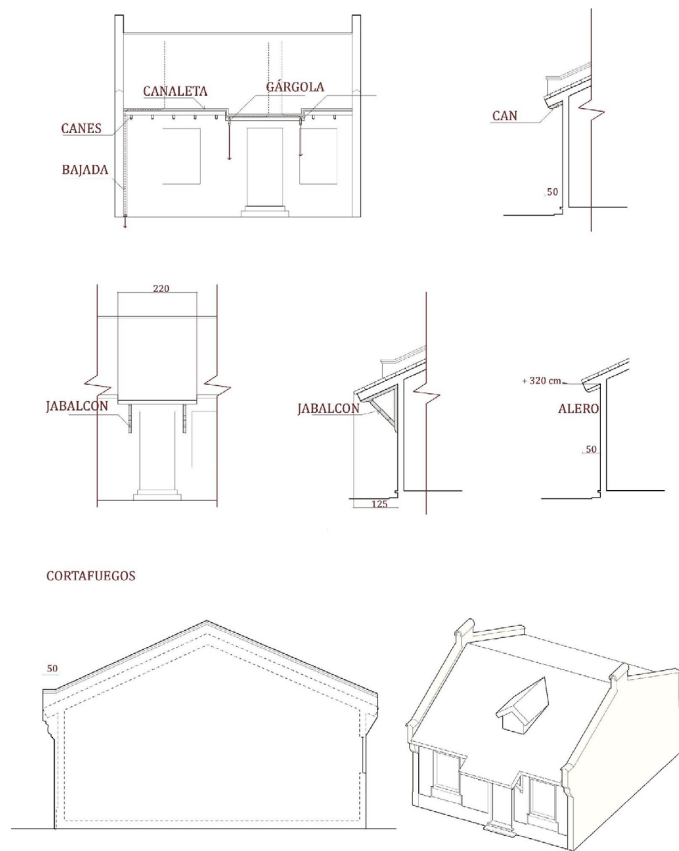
Elementos en ZT Población Caja del Seguro Obrero. Fuente: Lineamientos de Intervención CMN.
